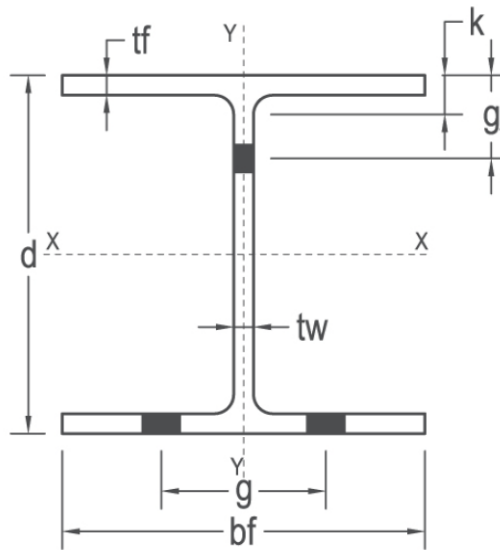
Dimensiones del perfil WF. Fuente: (Gerdau Corsa, n.d.)
